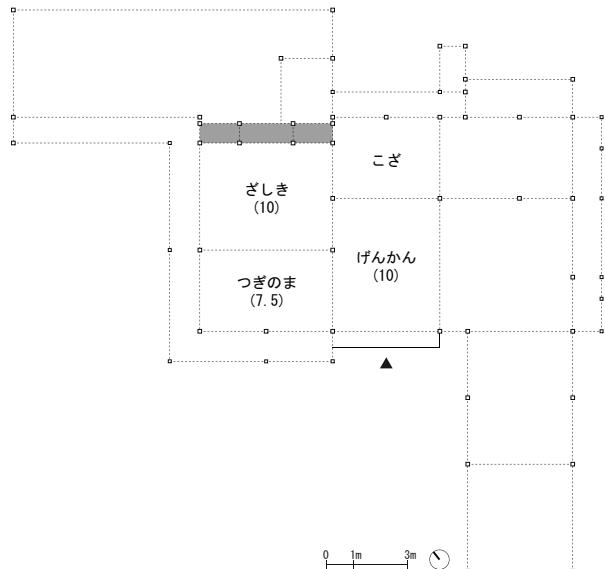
Sh 家住宅復元平面図 (江戸末～明治初)
